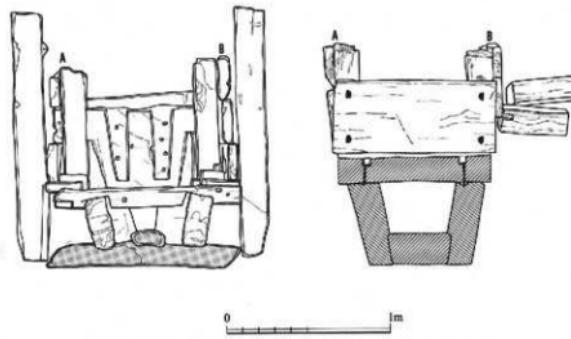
中桶這構桶本体正面立面図 ⑩・同背面立面図 ⑪ (S=1/30)
